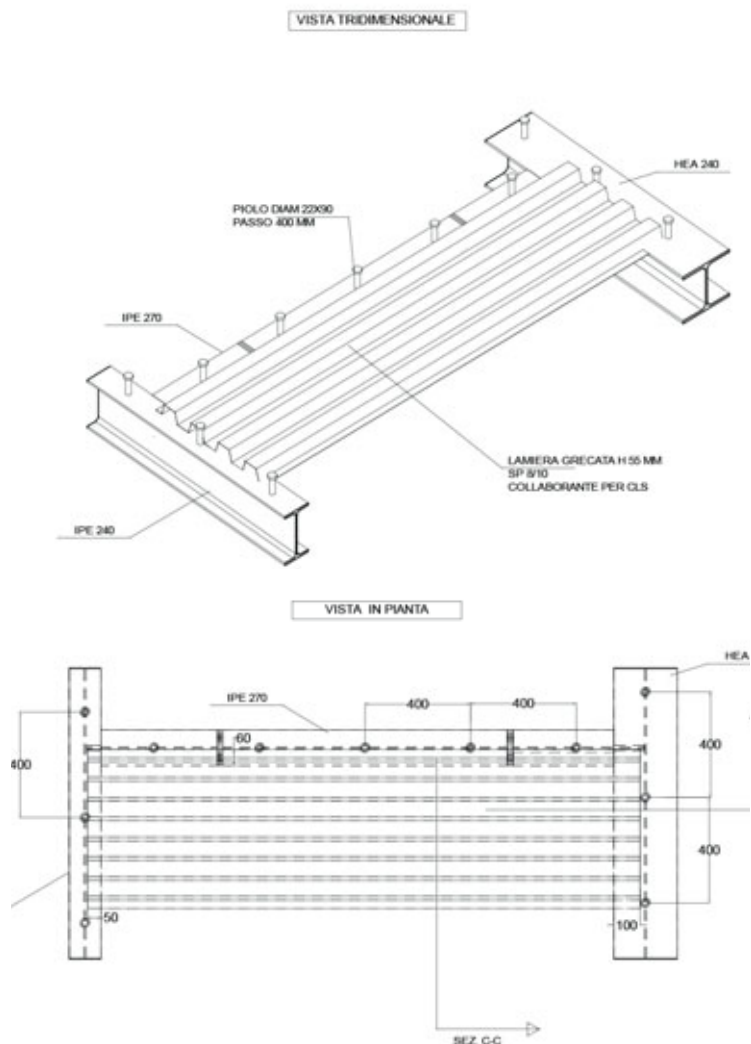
Dettaglio costruttivo del solaio in lamiera grecata collaborante e posizionamento connettori a piolo. © Carpenteria S.A.C.I.F. Srl
